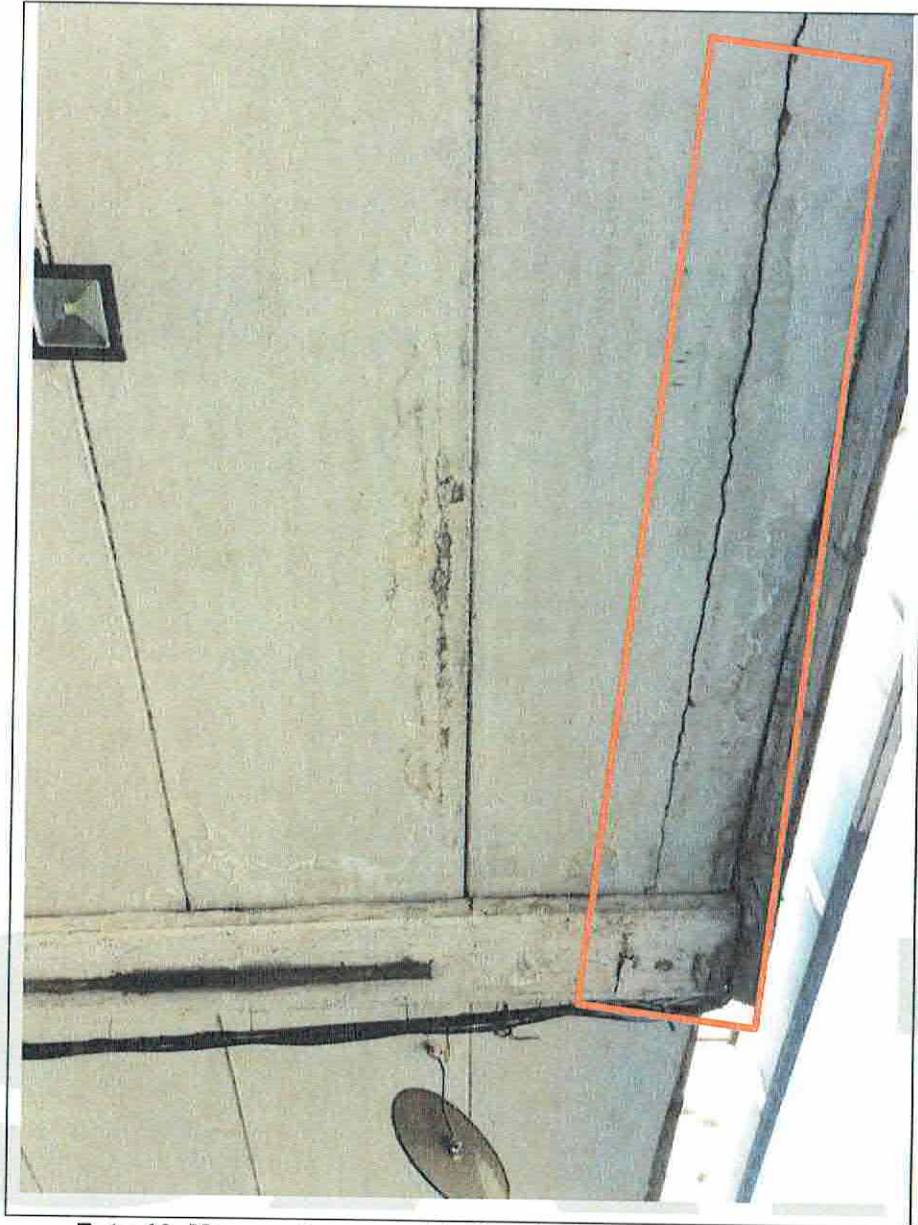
Grietas en aplanados por elementos fijados a la estructura pero sin formar parte de ella o aportar rigidez. Edificio de Administración central.
